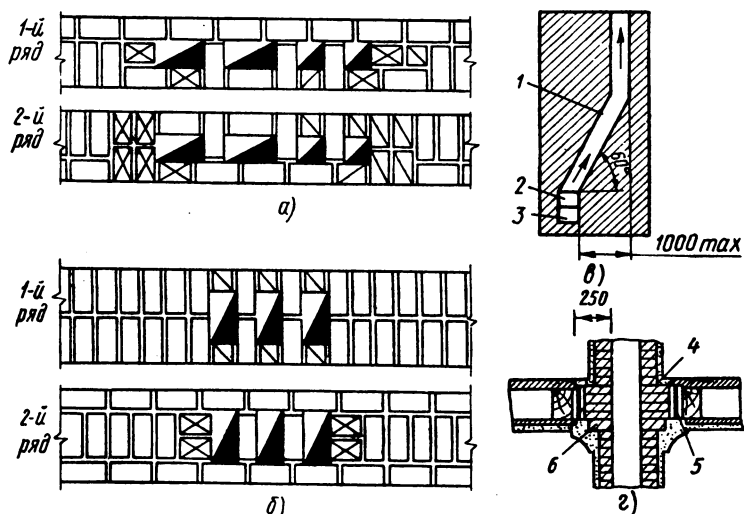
Вентиляционные каналы и газоходы в стенах (*а*, *б*), отвод канала (*в*), разделка дымохода у деревянного перекрытия (*г*):
